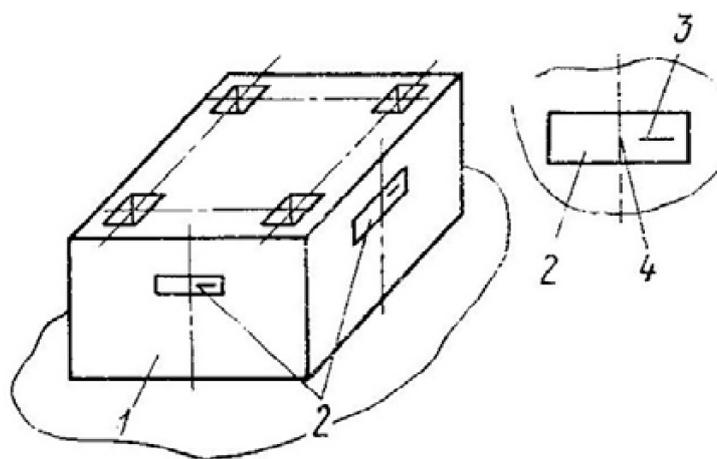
Схема планки для нанесения на фундаментах осей и высотных отметок:
